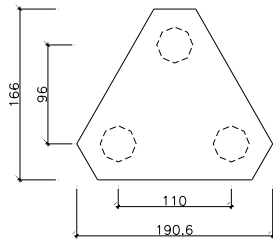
Plano de locação das estacas para Bloco do tipo II.
